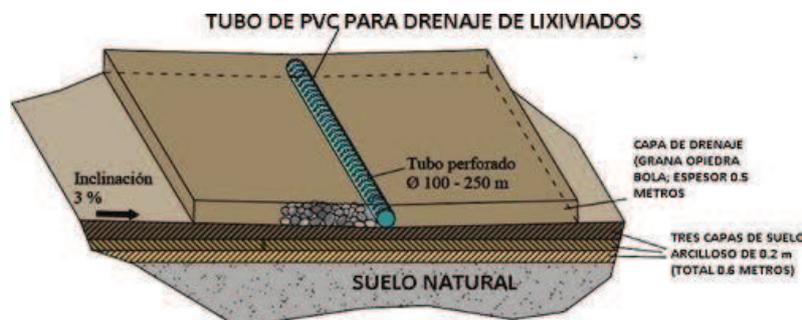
Sistema de drenaje interno para lixiviados con tubería de PVC
